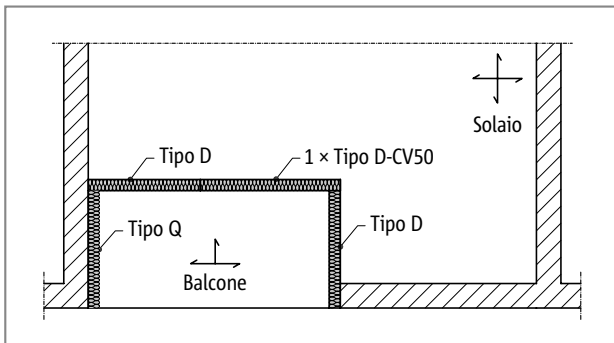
Schöck Isokorb® tipo D e tipo Q, solaio bidirezionale. Il vincolo di incastro di Schöck Isokorb® è in questo modo soltanto monoassiale
